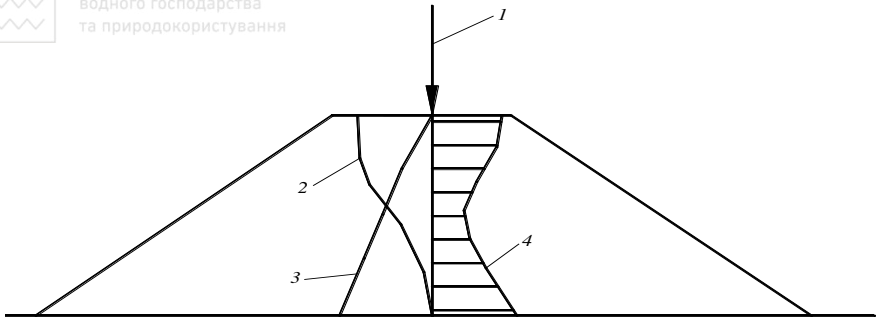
Розподіл тиску від транспортних навантажень і власної ваги ґрунту в земляному полотні: 1 – навантаження; 2 – епюра від зовнішнього навантаження; 3 – епюра напружень від власної ваги ґрунту; 4 – сумарна епюра напружень
